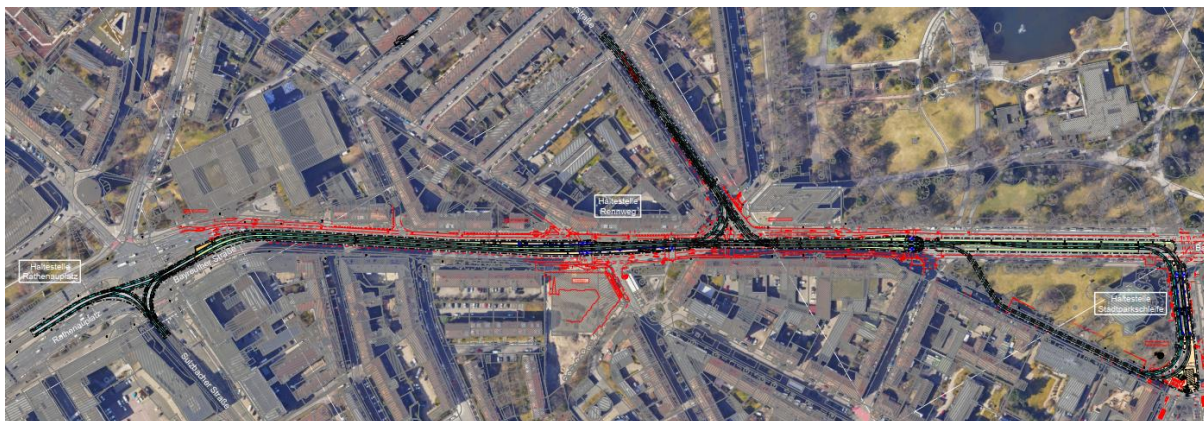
Übersichtslageplan mit Luftbild (Unterlage 03.1)
